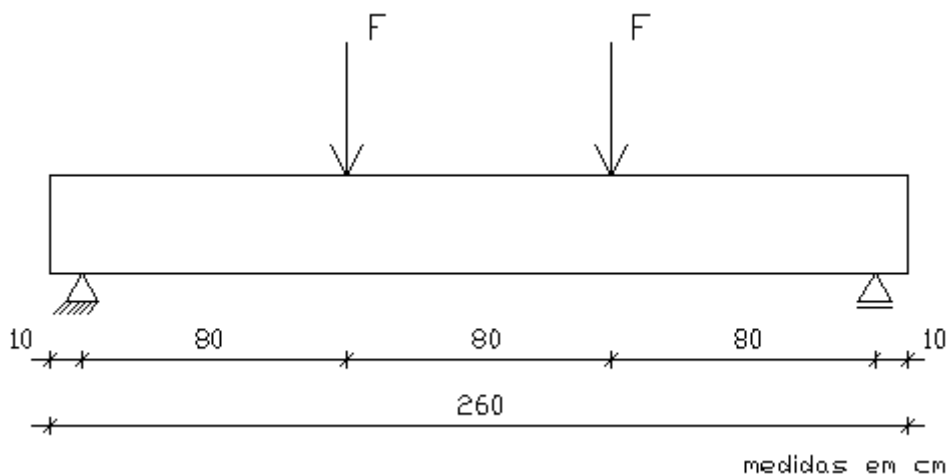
Posicionamento dos apoios e das cargas nas vigas da experiência 1 (MASSONI, 1996)
